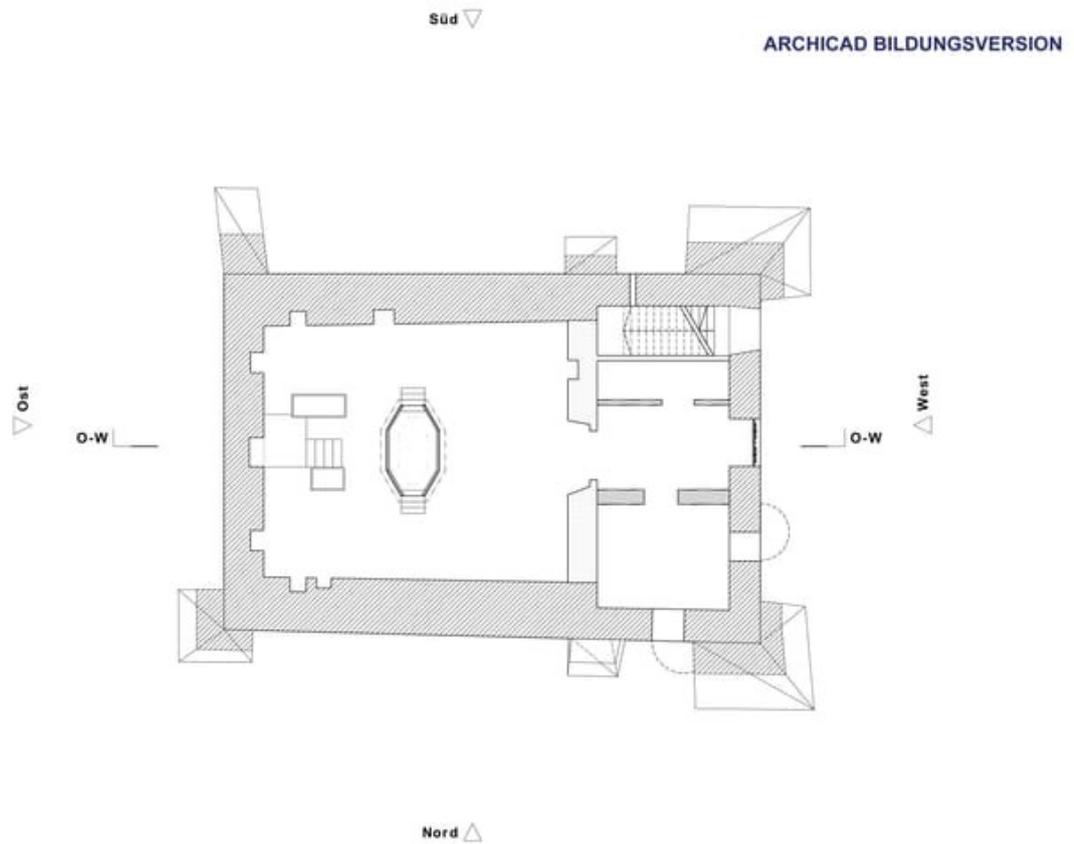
Grundriss EG Rekonstruktion.pdf
